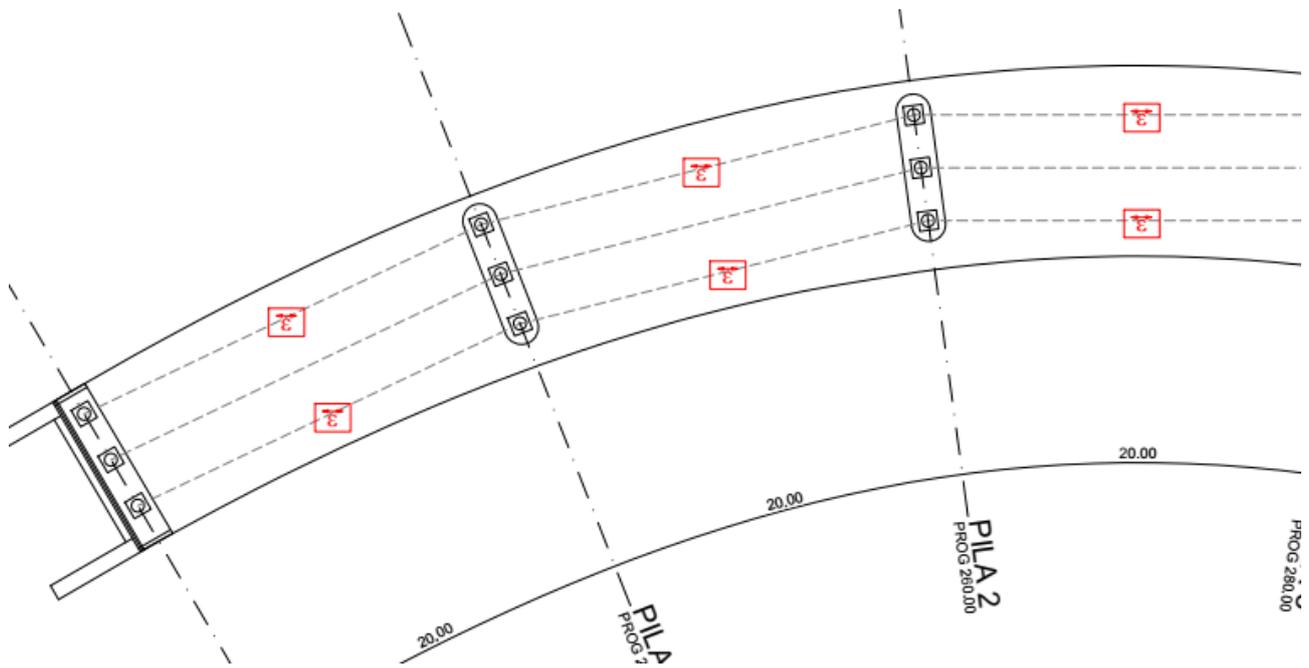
Ubicazione sensori su impalcato sezione a 3 travi (Pianta Rampa Uscita SS75)
